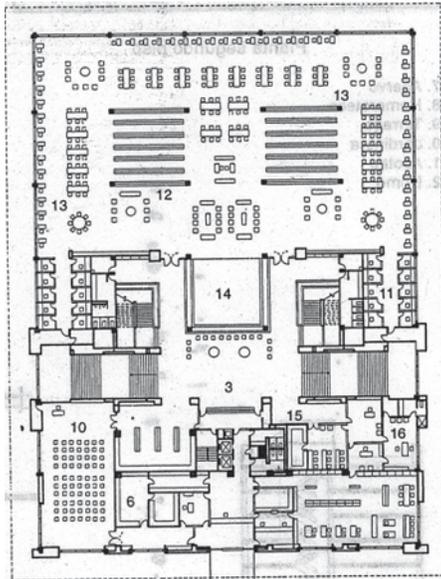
Planta de la Biblioteca de la Universidad Anahuac,
